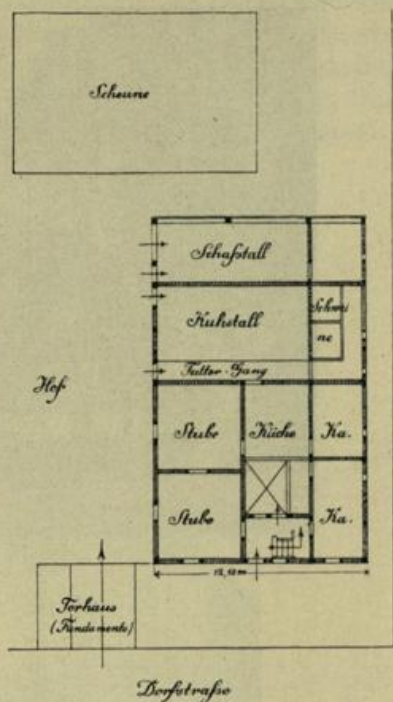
Herzberg. Haus Kùgow, Grundriß.
